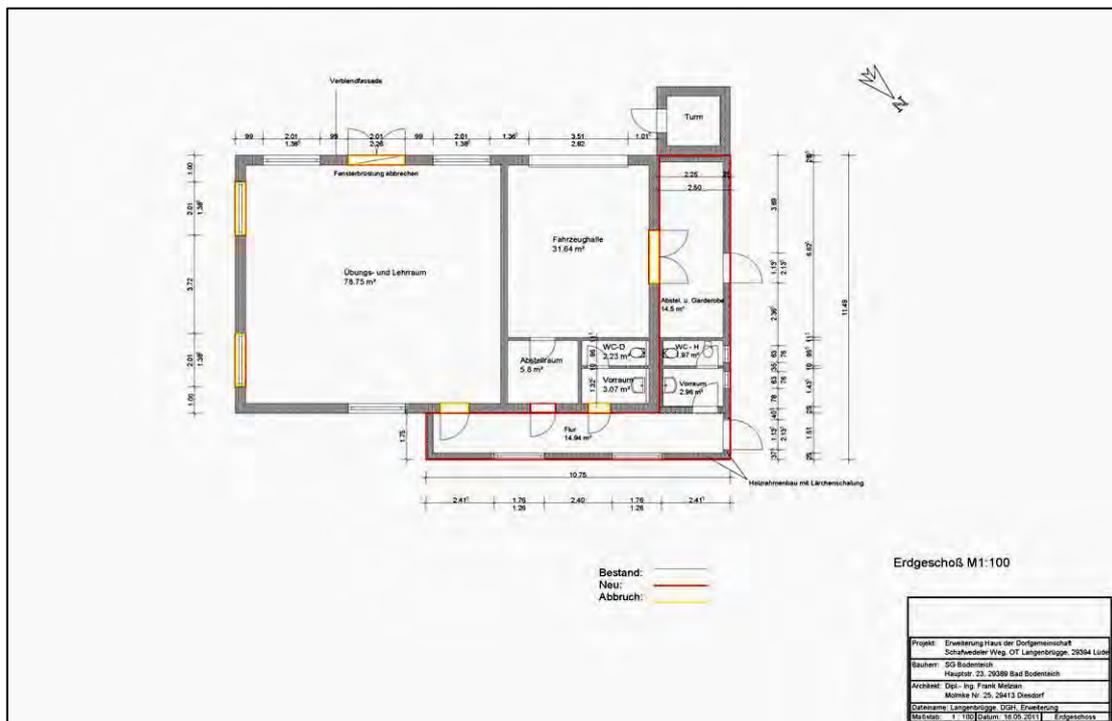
Grundriss - Erweiterung zum DGH in Langenbrügge (F.Melzian Dipl.-Ing)
